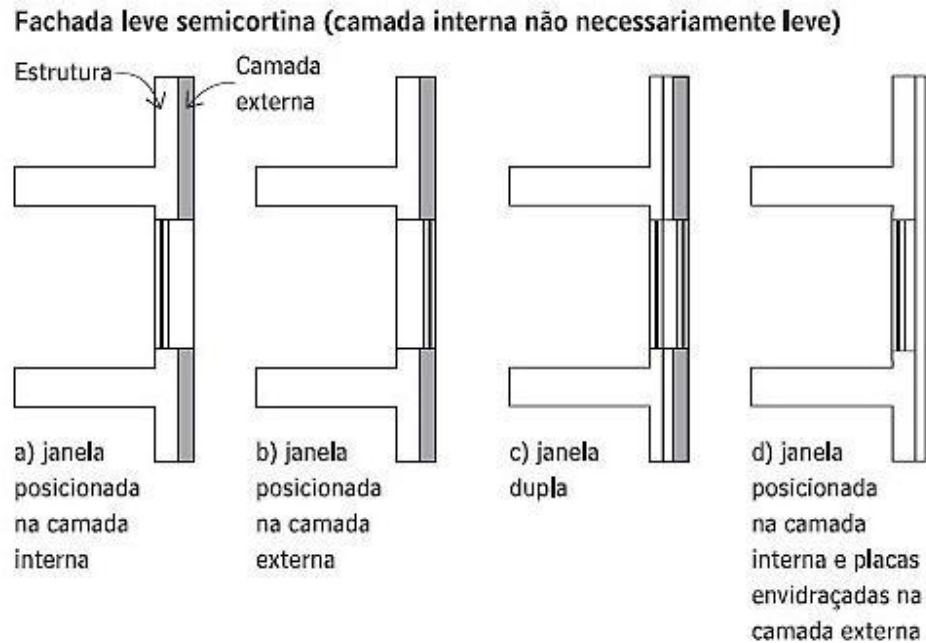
Esquema de seção longitudinal de fachadas semicortina constituídas por várias camadas
